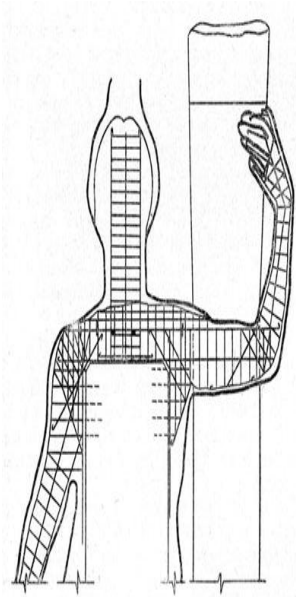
Арматура верхней части железобетонного основания скульп., 1951г.
